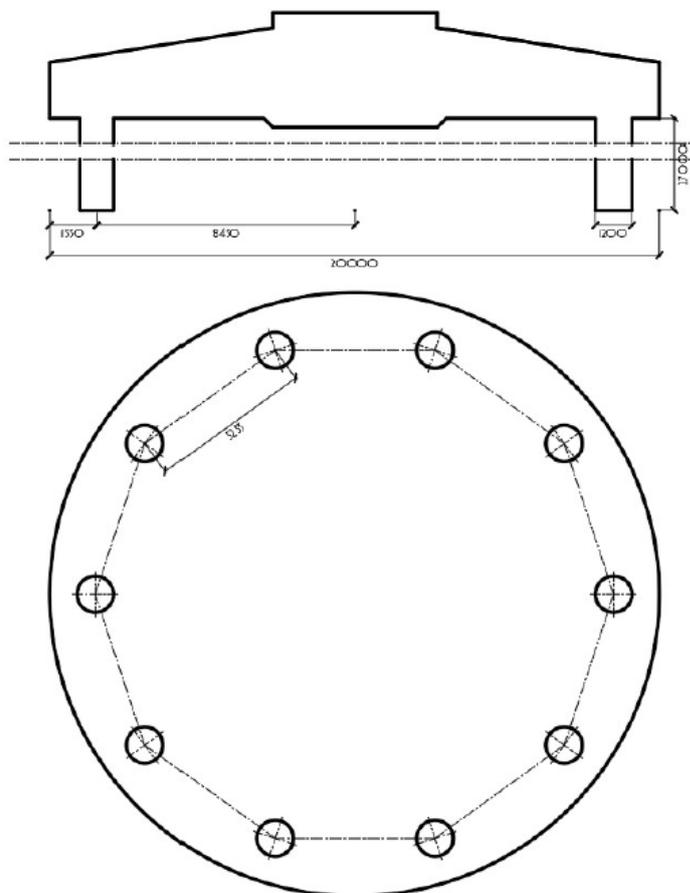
Schema esemplificativo della fondazione tipo con pali
